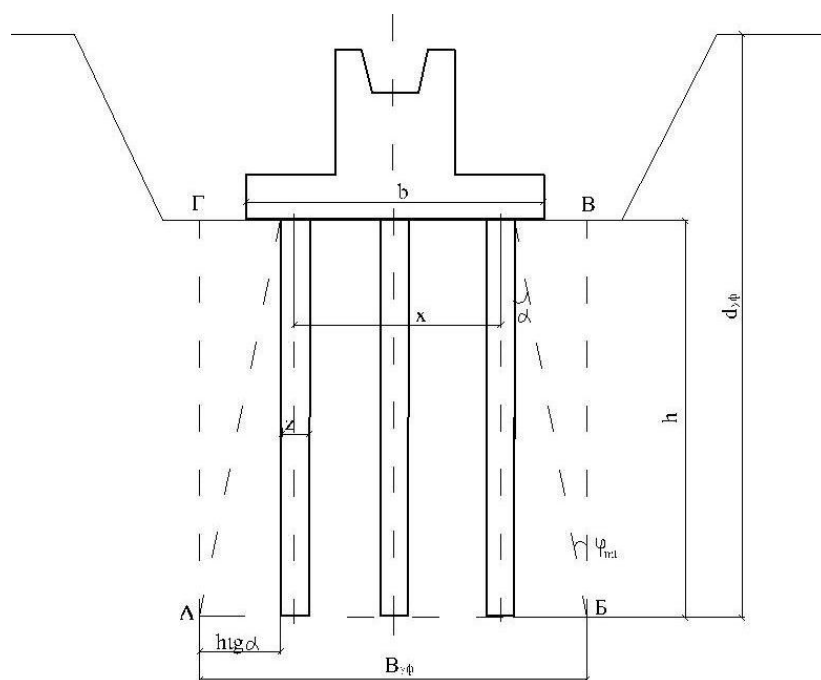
Расчетная схема свайного фундамента по деформациям
